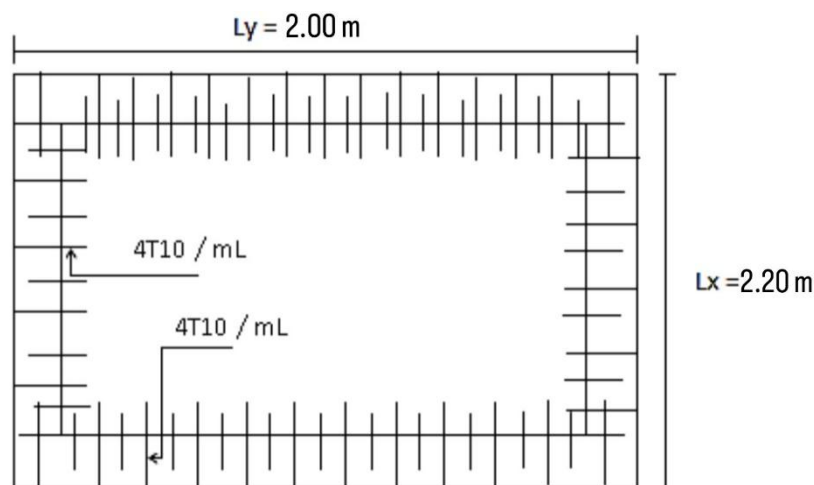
Ferrailage supérieur de la dalle de l'ascenseur.
